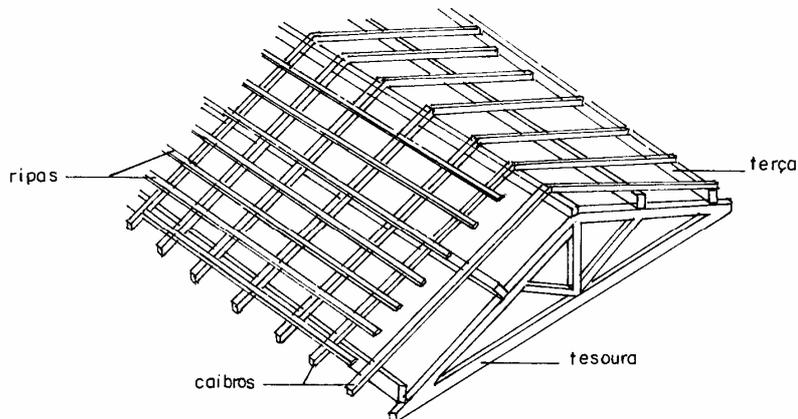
Estrutura de madeira. Fonte: FACENS, 2001.
